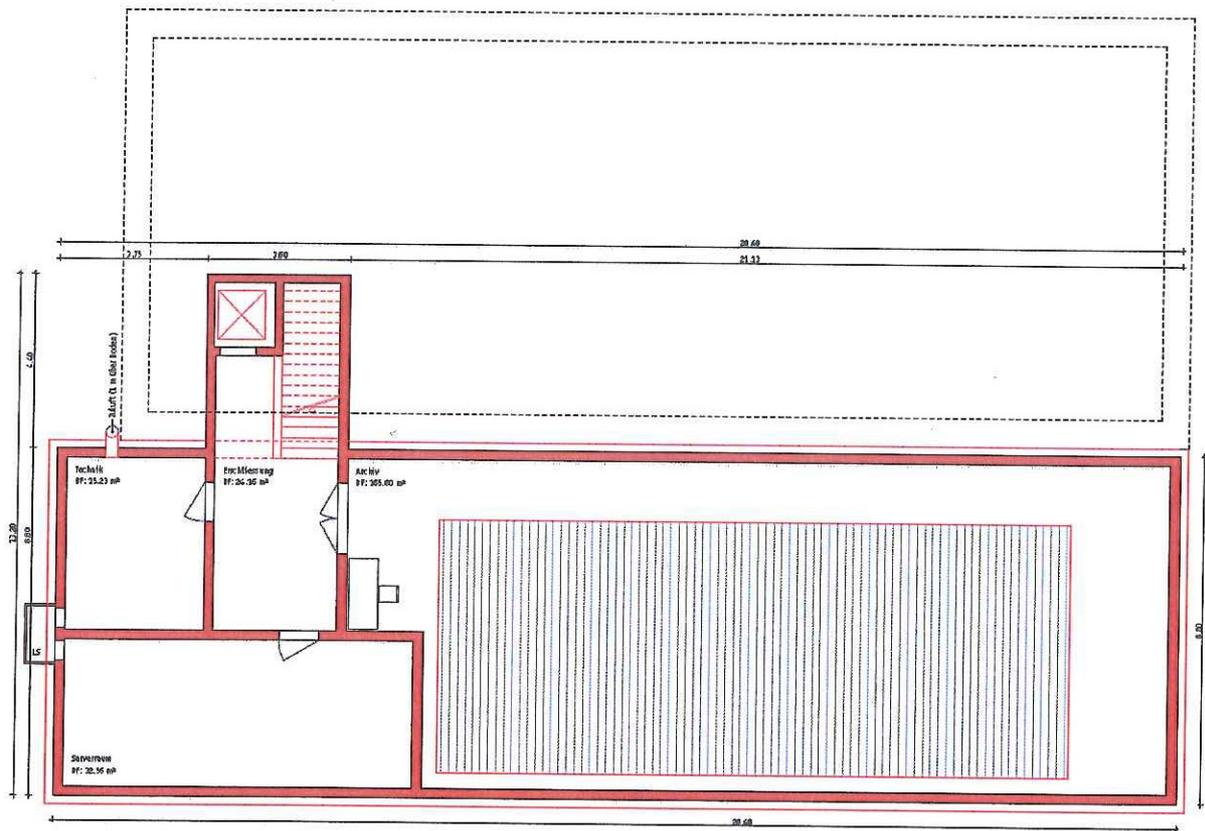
Grundriss des geplanten Untergeschosses
